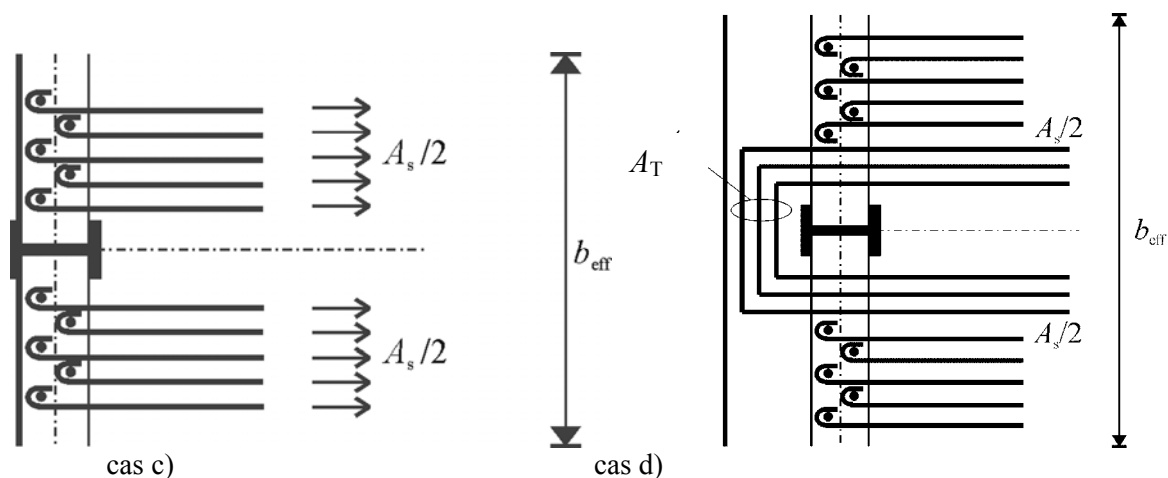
Transfert d'un moment négatif $M < 0$ à un poteau de façade. Cas c) Détails pour le transfert de M en cas de poutre de façade en acier. Cas d) Cas combiné : bande de rive en béton + poutre de façade en acier.
